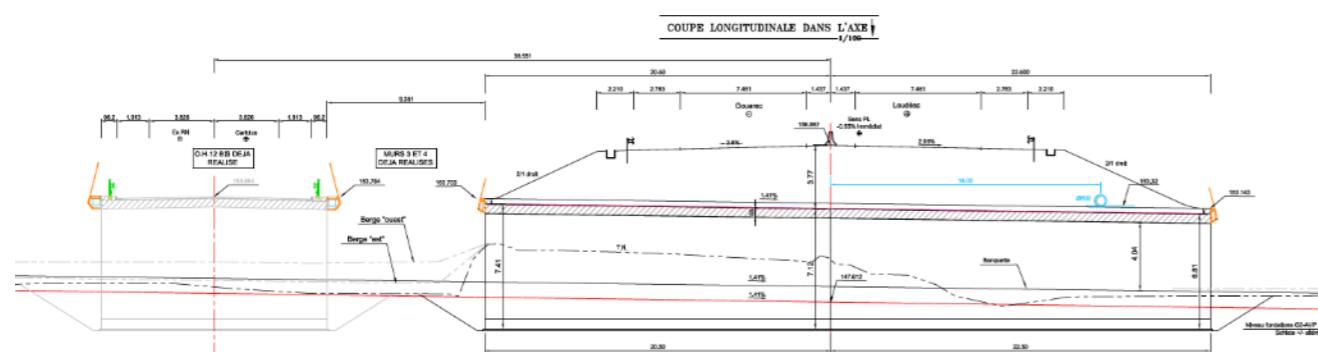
Coupe longitudinale de l'ouvrage OH12 (source : SEGIC)
